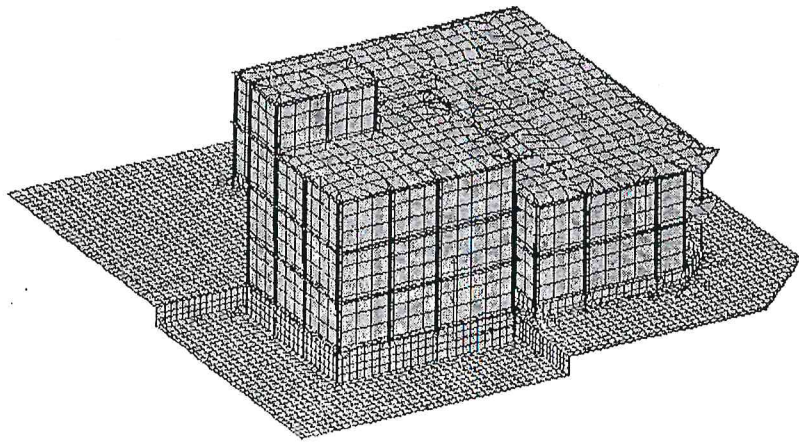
Расчетная схема с пристройкой 3х этажного здания ниже на 1,2 м от уровня существующего здания
